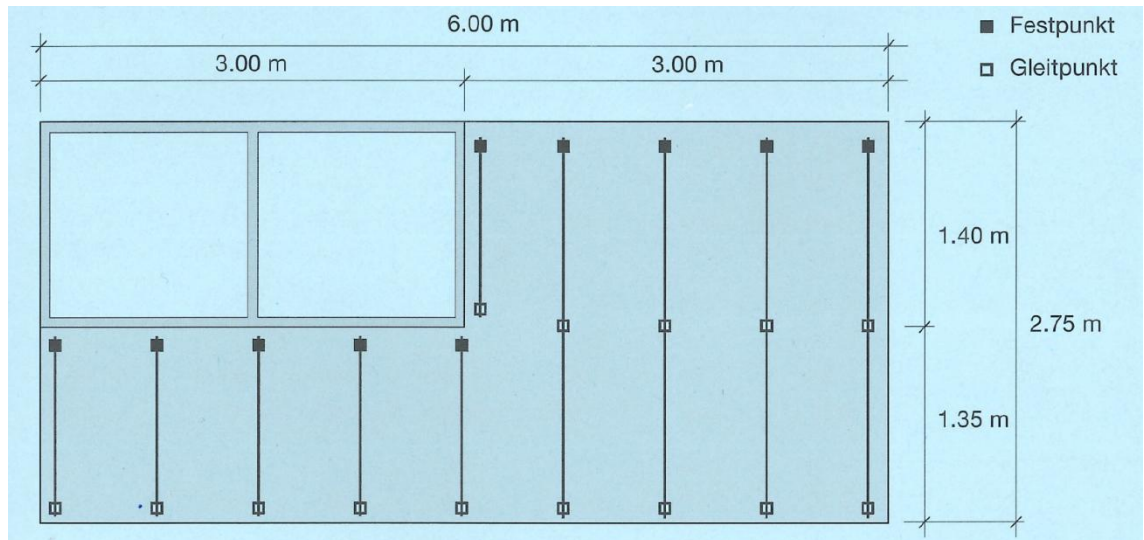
Montageschema für typischen Fassadenausschnitt [BFE98]
